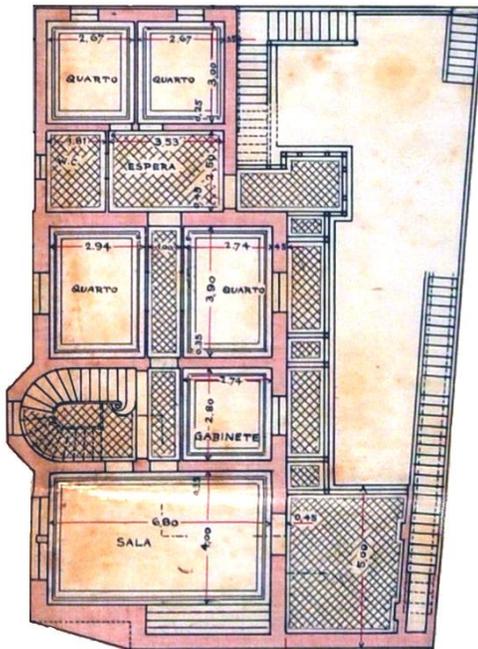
e 147: Planta baixa do pavimento de acesso e do pavimento superior
